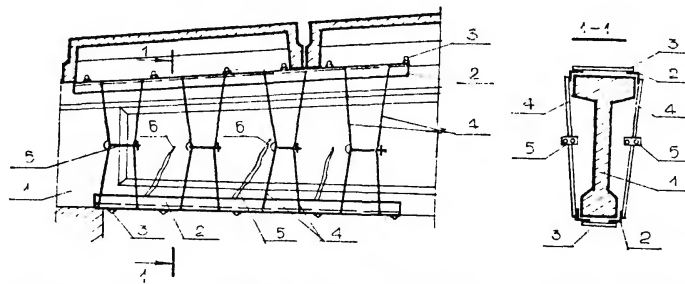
Установка предварительно напряженных поперечных стержней в опорных частях
